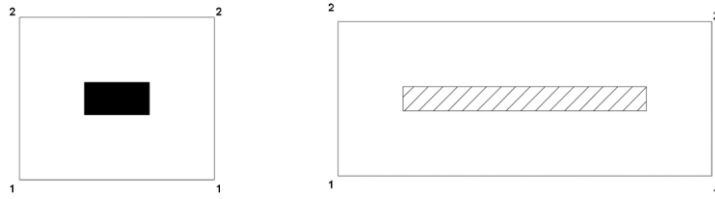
Esquema para determinación de esfuerzos – zapata conectada
